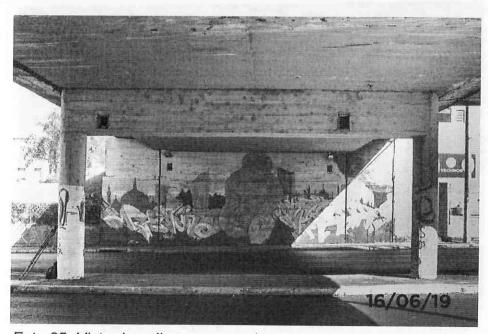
Vista dos pilares com a viga travessa e apresentando bolor e caixa de passagem de elétrica sem tampa
